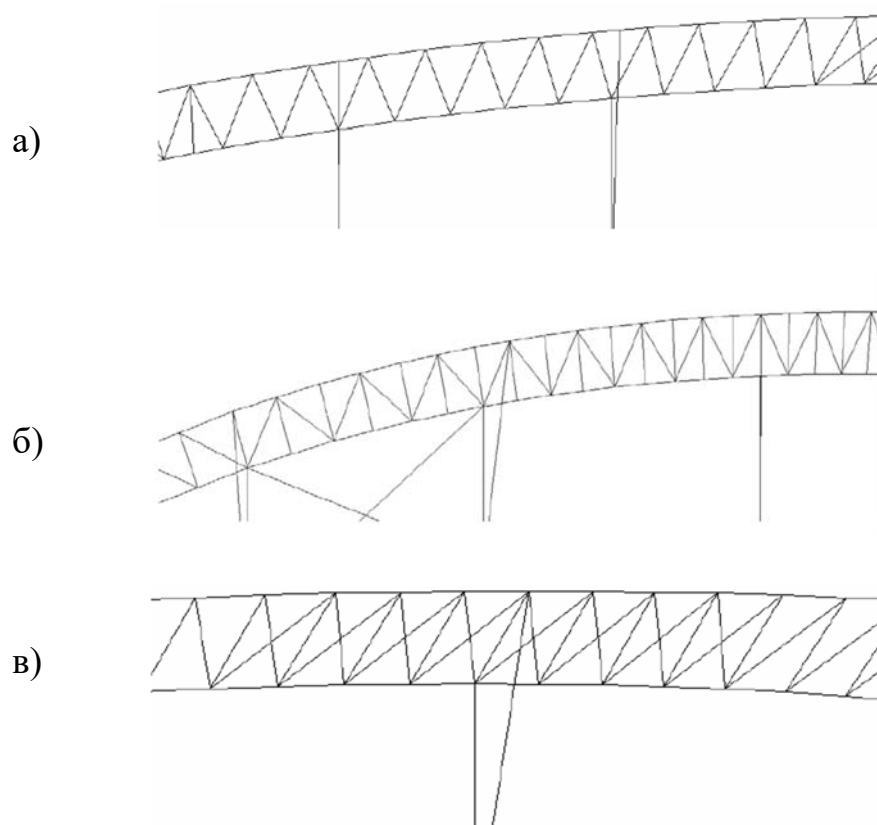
Прийняті схеми поясів просторової ферми: а) – розкісна; б) – розкісна з проміжними стійками; в) – перехресна
